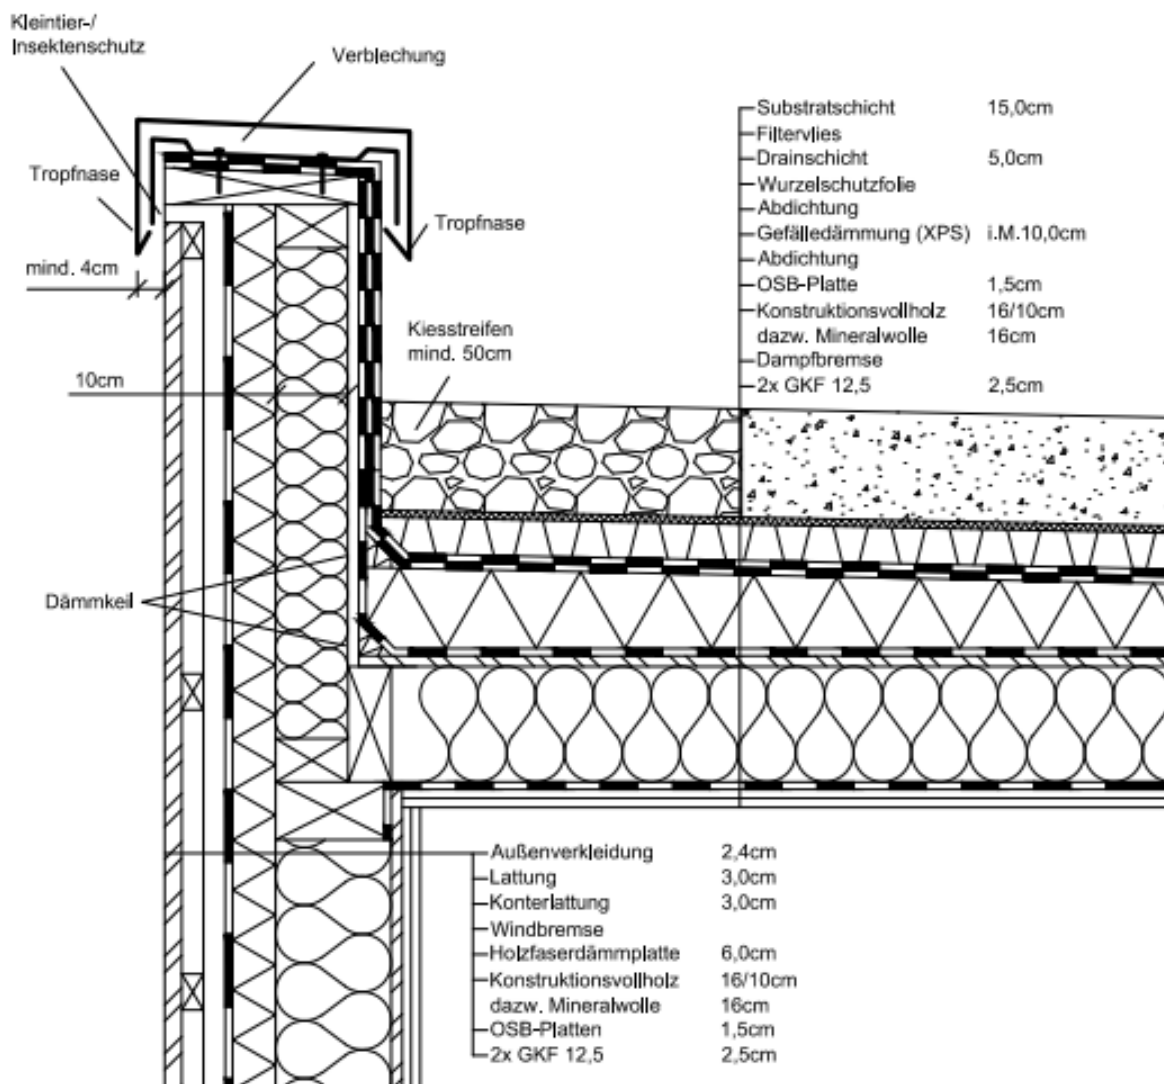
Detail 01 - Anschluss AW an Flachdach
